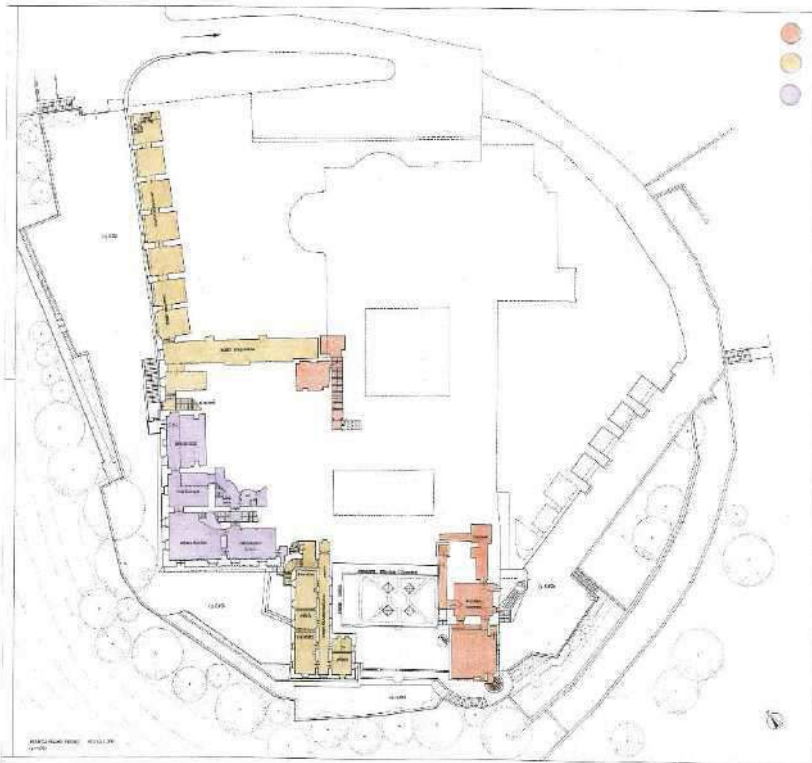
Pianta piano seminterrato; in giallo, nella zona sud, la biblioteca CAI, in rosso la biblioteca conventuale
